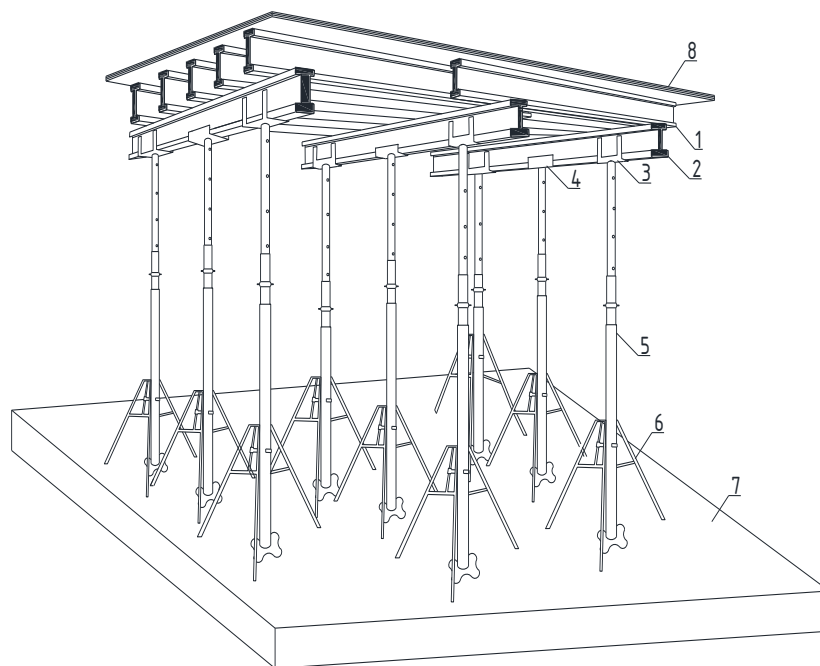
Узел установки горизонтальной опалубки: 1 – второстепенная балка; 2 – главная балка; 3 – унивилка; 4 – промежуточная удерживающая головка; 5 – стойка; 6 – тренога для фиксации стоек; 7 – плита перекрытия; 8 – трехслойная плита.
